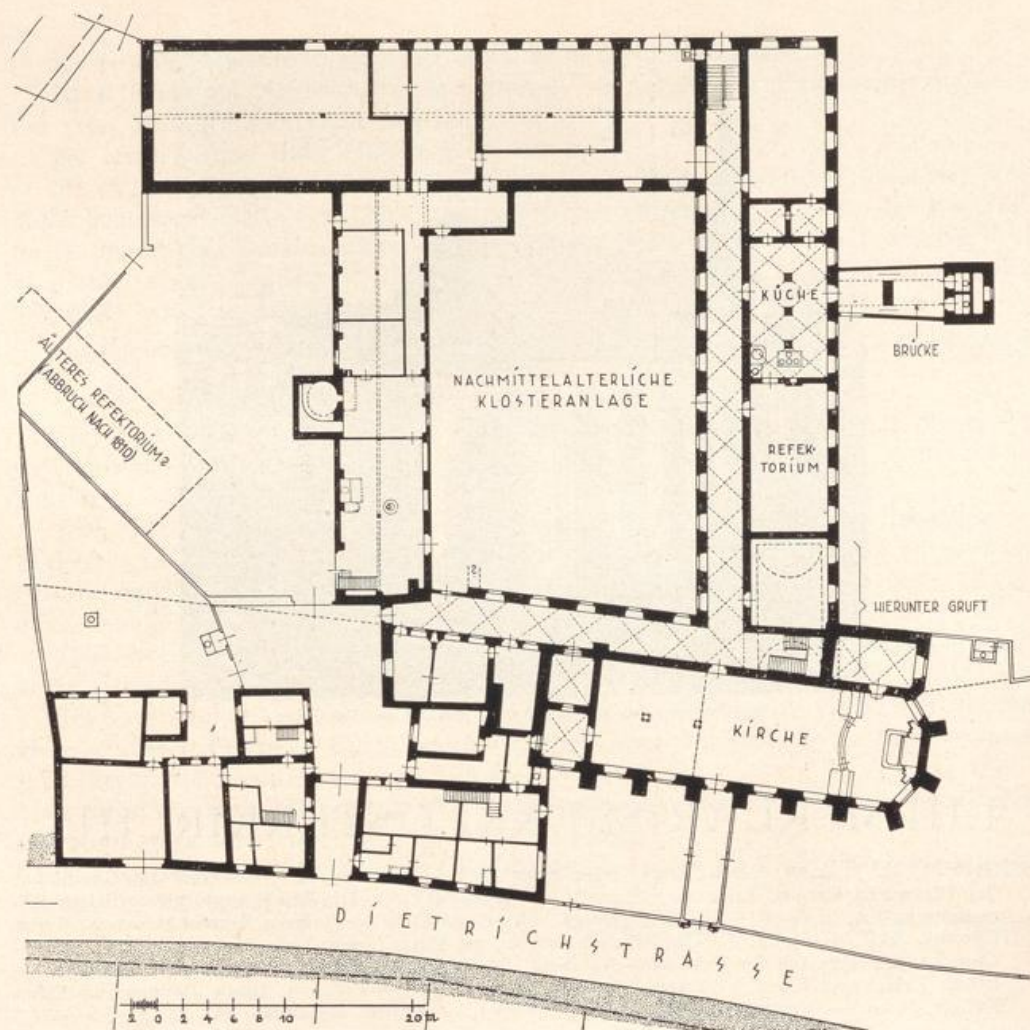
Klarissenkloster und -kirche. Grundriß.
